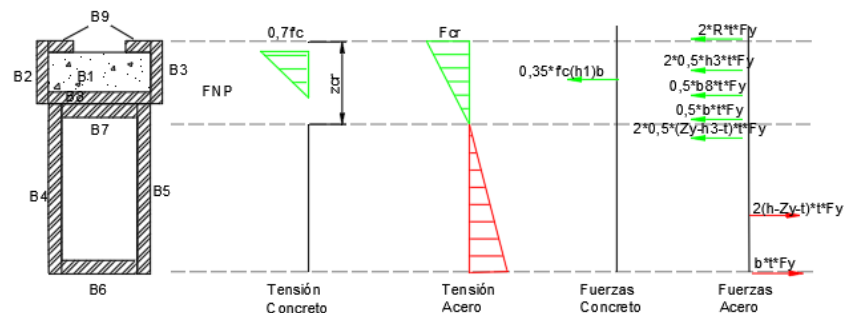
Distribución de tensiones y fuerzas en la Sección N°6 en el rango plástico.
